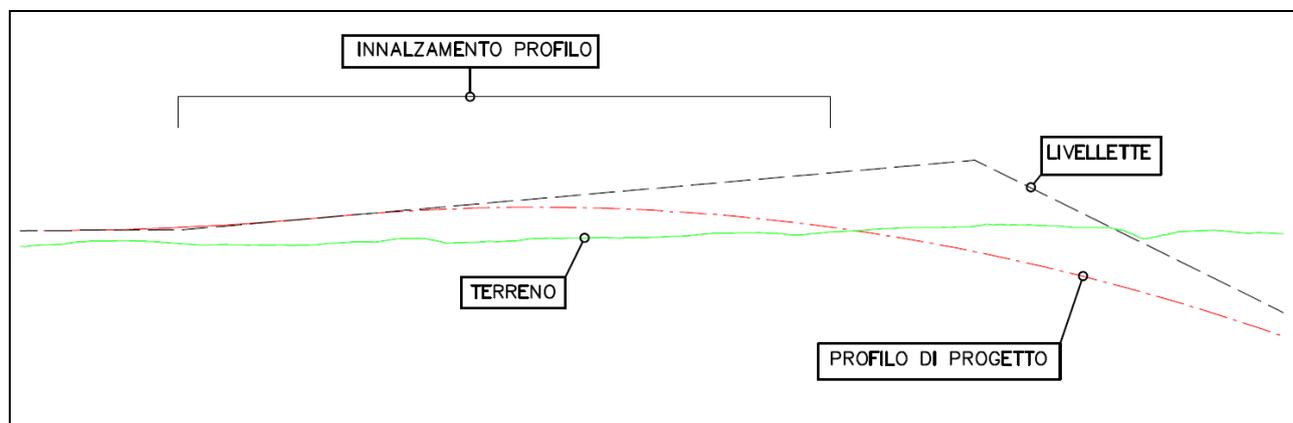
INNALZAMENTO DEL PROFILO DI PROGETTO IN CORRISPONDENZA DELLE RAMPE DI ACCESSO AL SOTTOVIA
